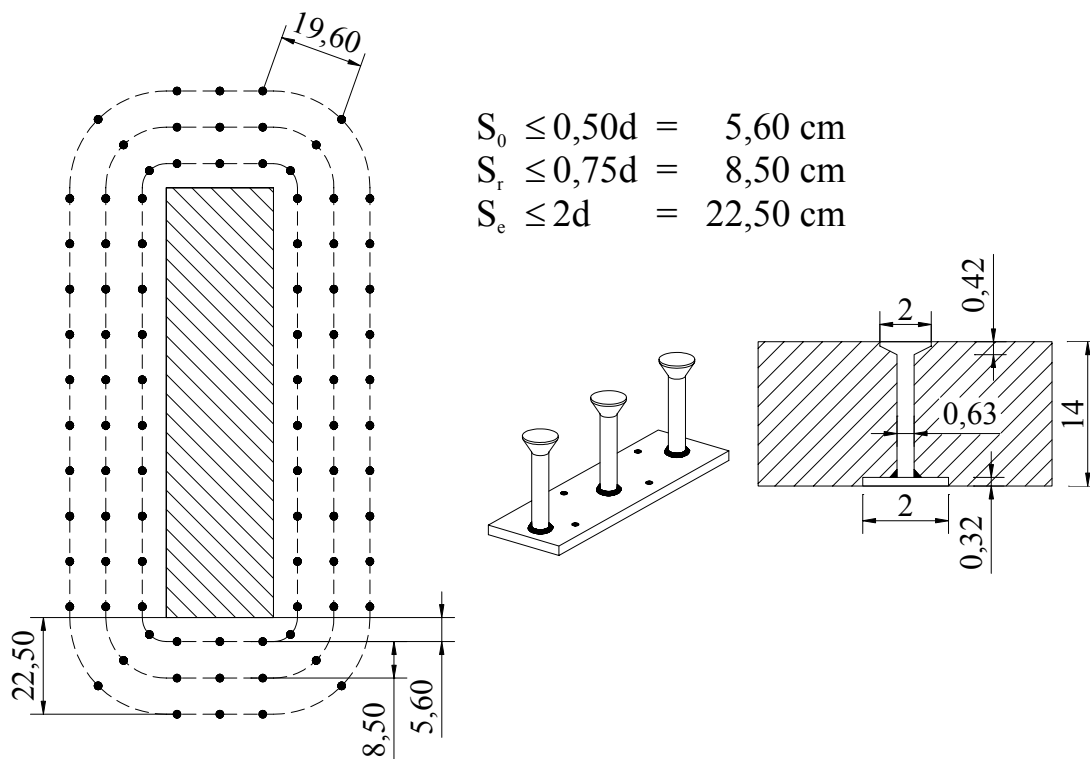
24 Detalhamento da armadura de punção no pilar P5
